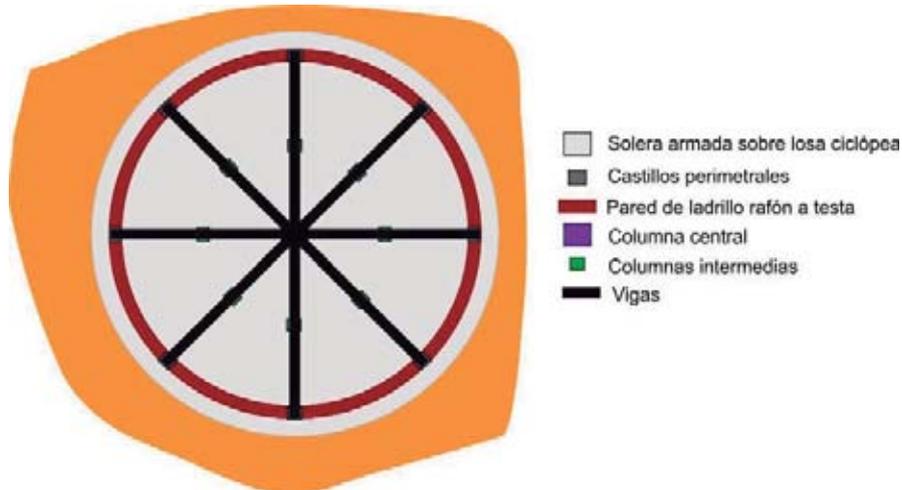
Disposición de las vigas soporte de la losa superior de cierre. Las columnas interiores intermedias son las encargadas de reducir la luz de la viga.
